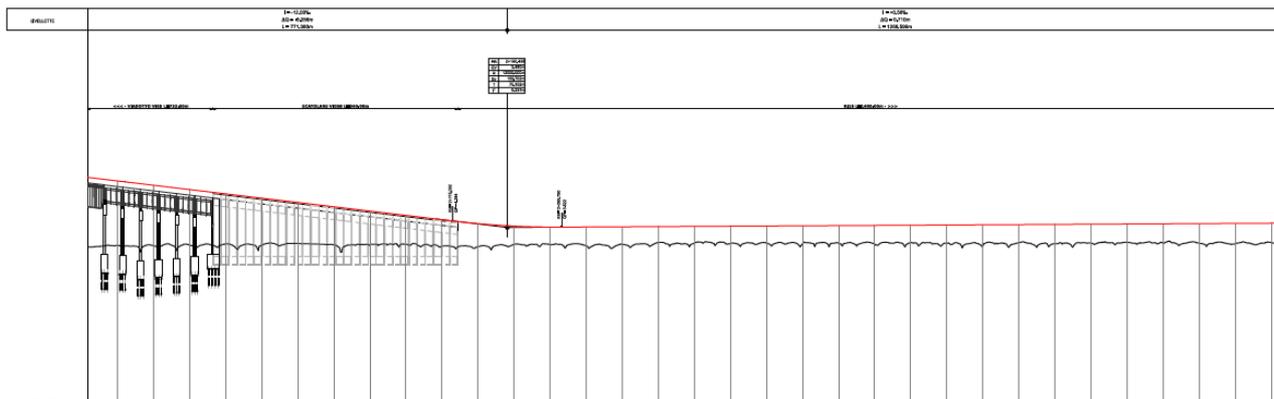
Stralcio del profilo longitudinale (km 0+00- km 1+600)
